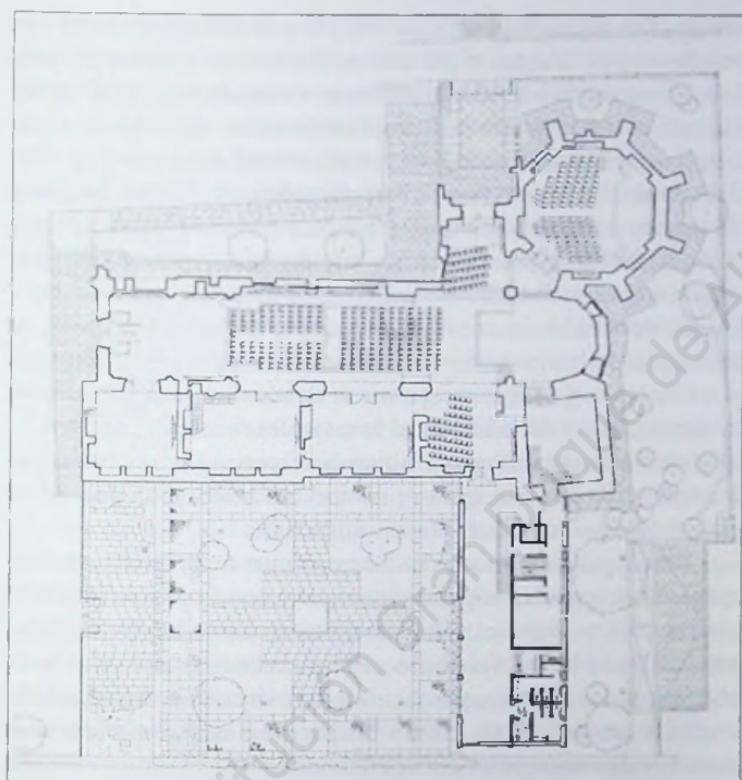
Plano de la planta baja amueblada (José Ramón Duralde).
